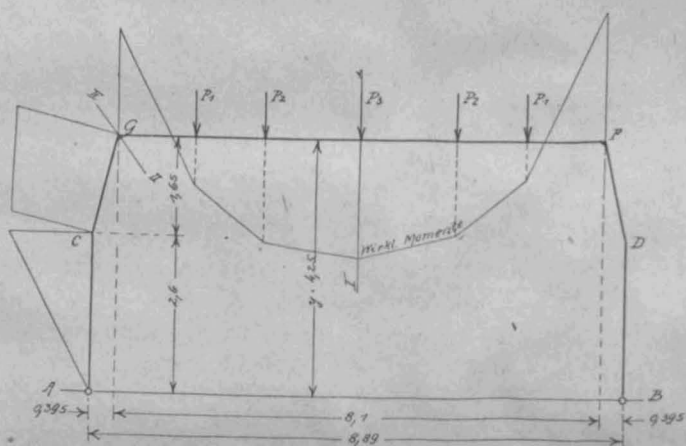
Belastungs-Schema und Momente der Dachbinder.
